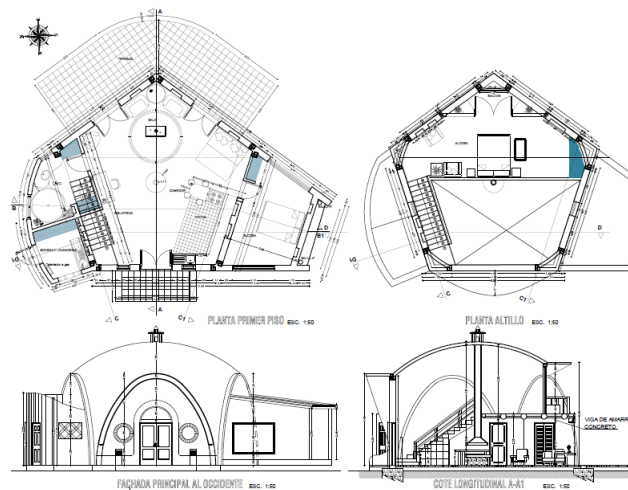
Plano arquitetónico de la obra (Lucia E Garzon)
